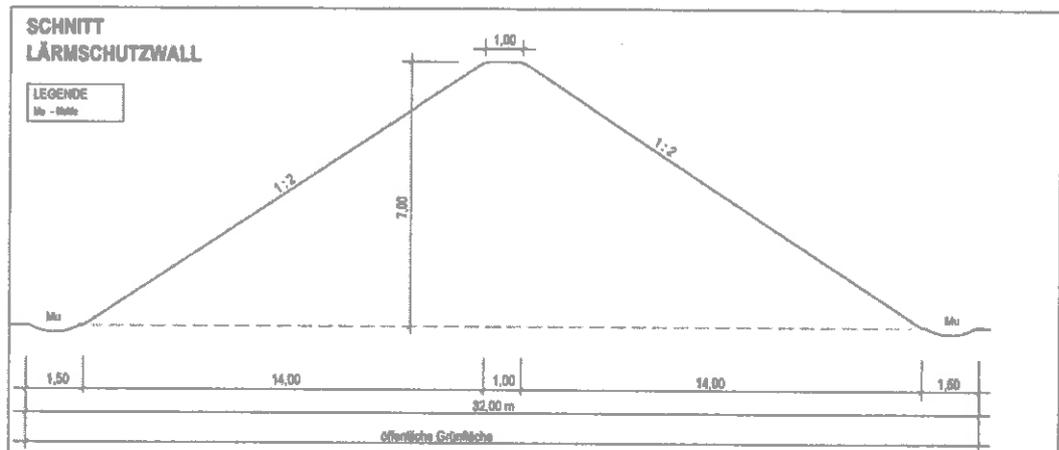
Schnittdarstellung des geplanten Lärmschutzwalls
